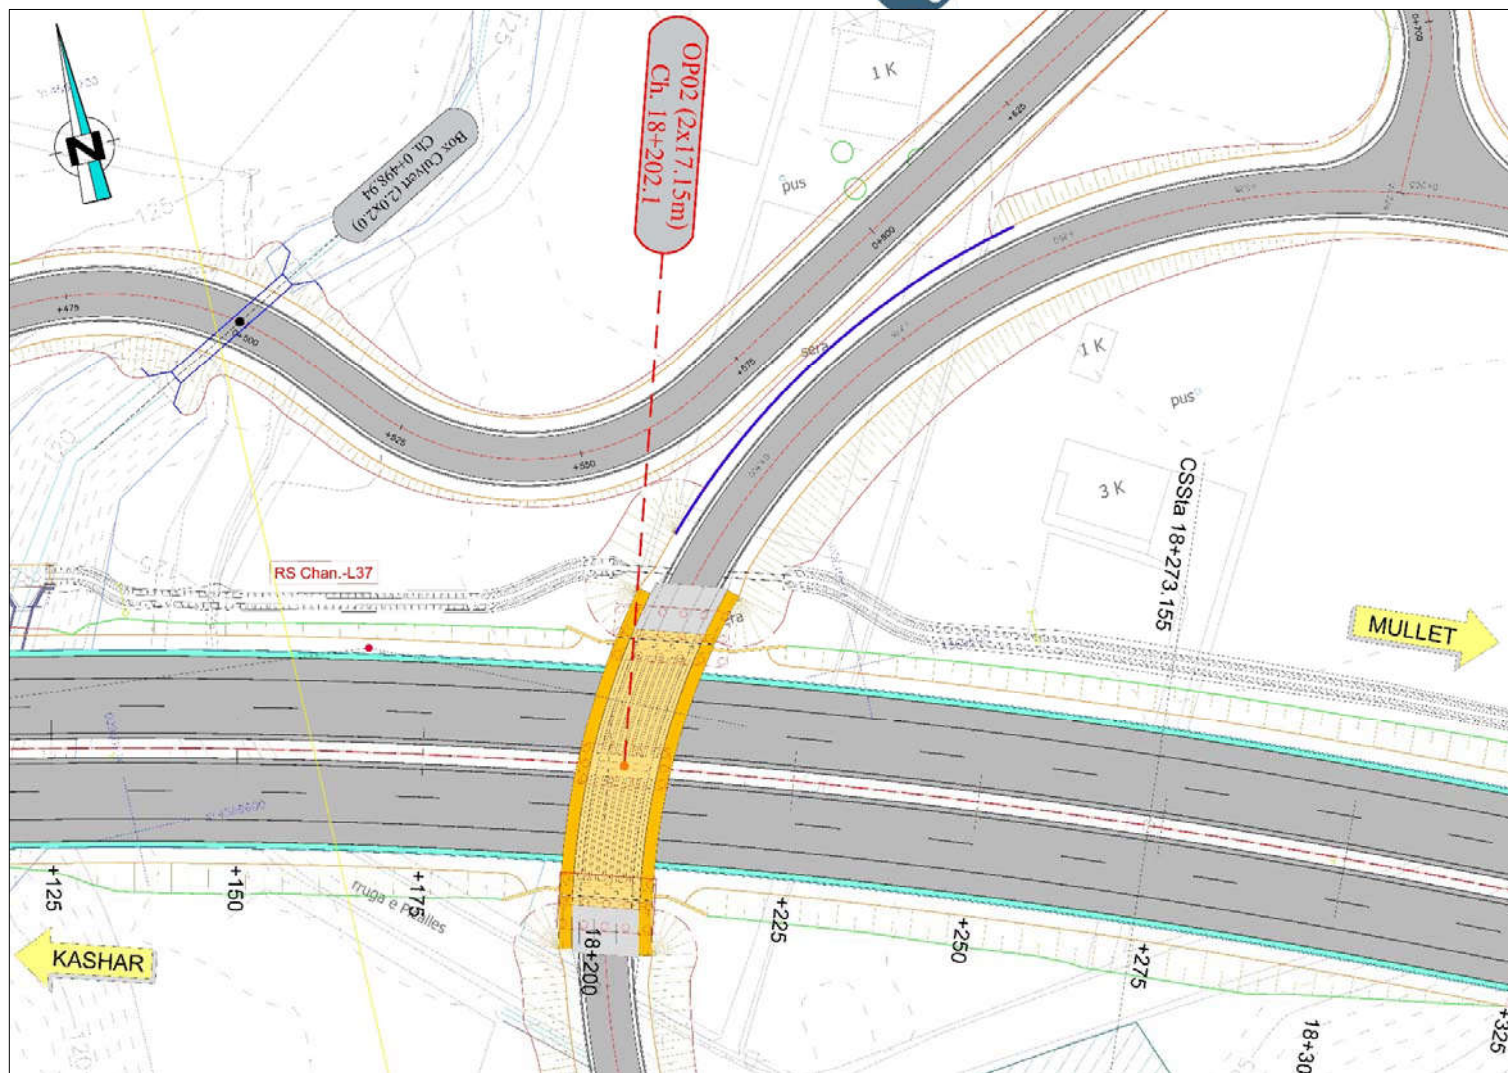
Pamje planimetrike e Mbikalimit 02, L=34.3m (Hapësira 2x17.15m)
